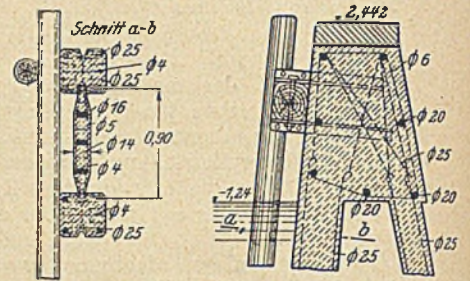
Querschnitt und waagrechter Schnitt der Eisenbetonkaimauer in Husum.
